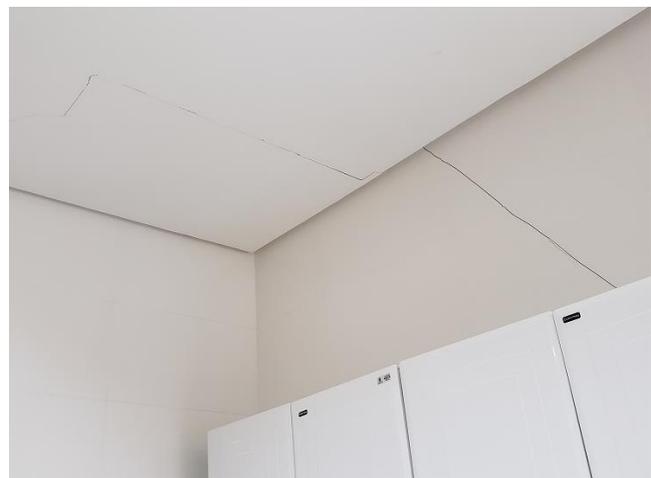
Rachadura nas parede e noteto (sala de vacinação do Centro Municipal de Saúde - Guarapari)
